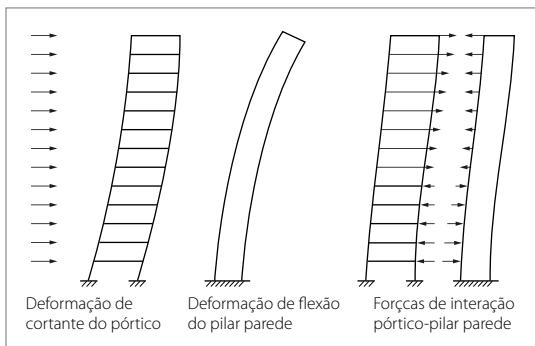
Interação pórtico - pilar parede ante cargas laterais.
